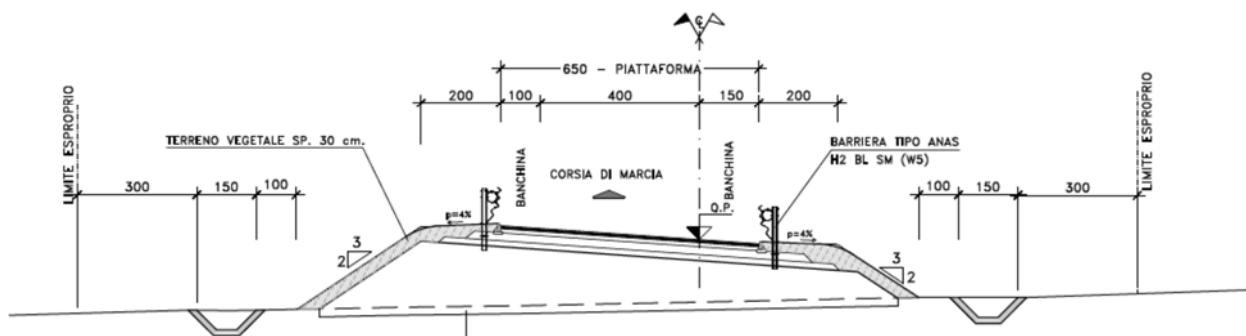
Sezione tipo Rampa di svincolo unidirezionale
